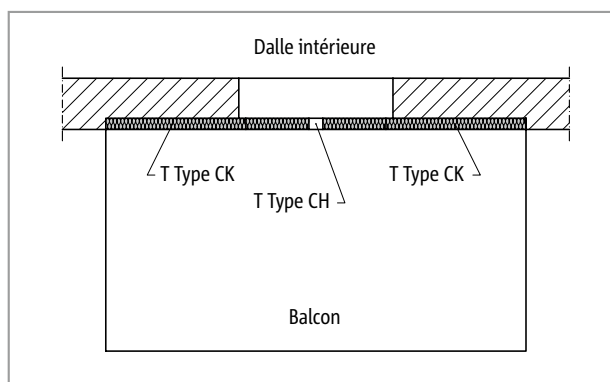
Schöck Isokorb® T Type CH : balcon en porte-à-faux
